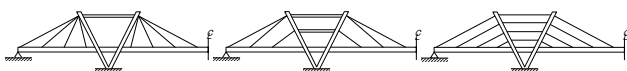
ケーブル角度を改善する斜張橋の構造例²⁾
